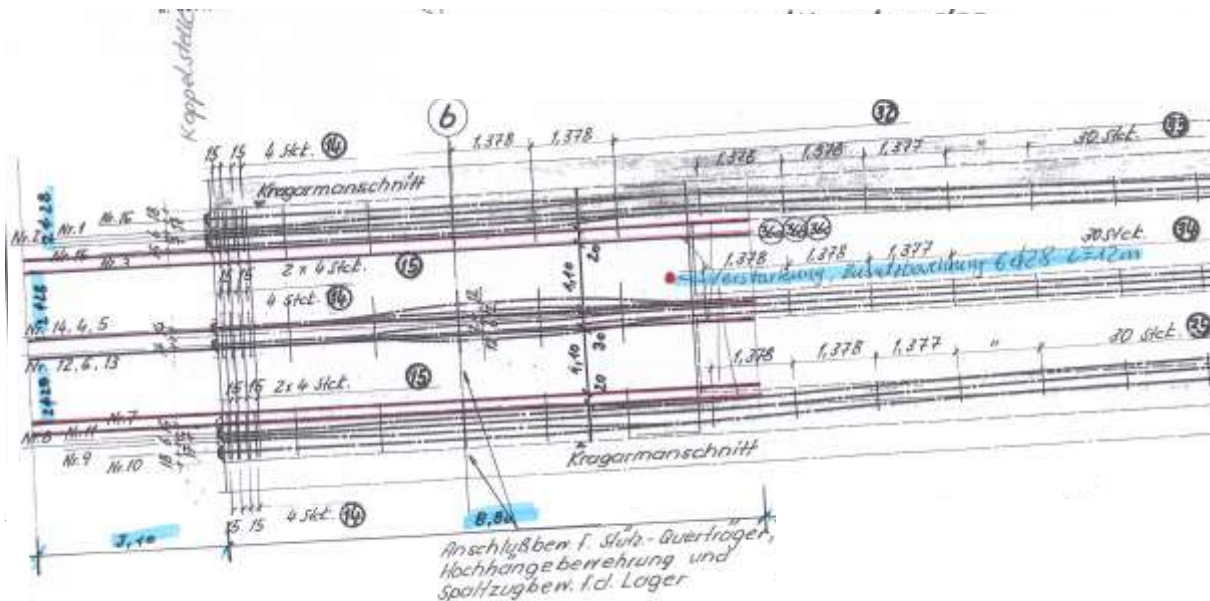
Horizontalschnitt unter der Fahrbahnplatte mit Zusatzbewehrung
